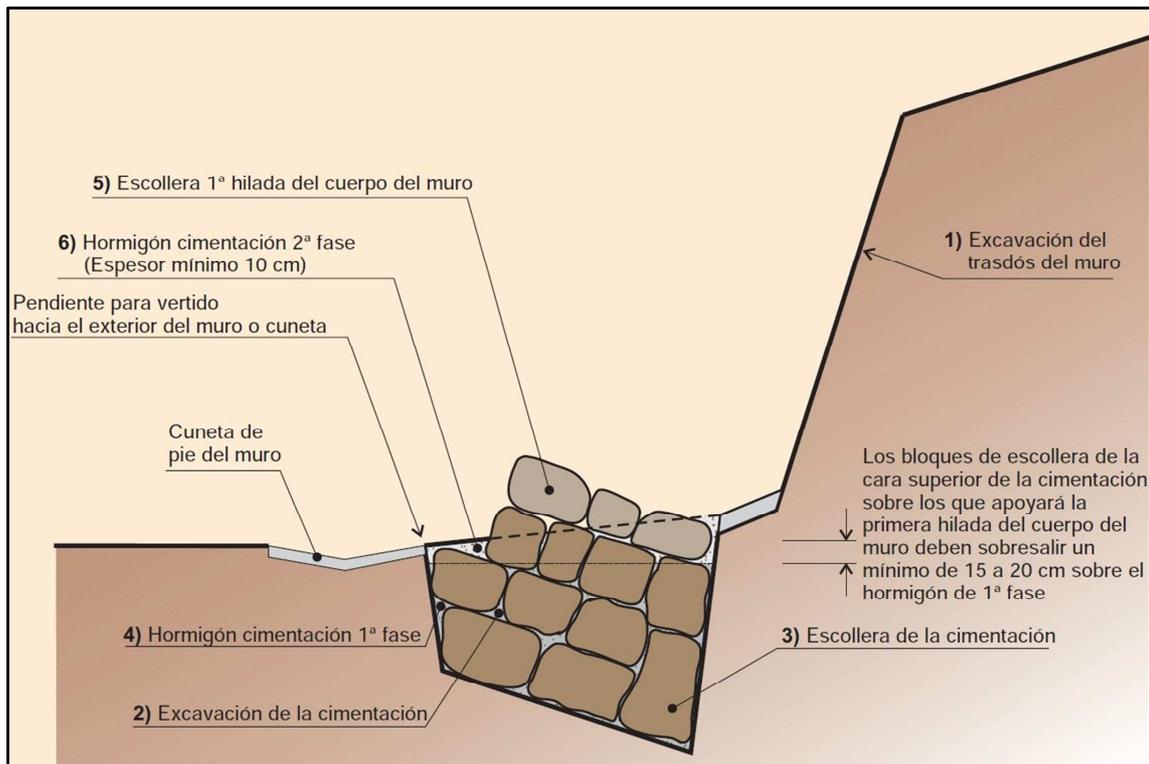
Fases de ejecución de la cimentación. Fuente: Guía para el Proyecto y la Ejecución de muros de escollera en obras de Carreteras del Ministerio de Fomento.
